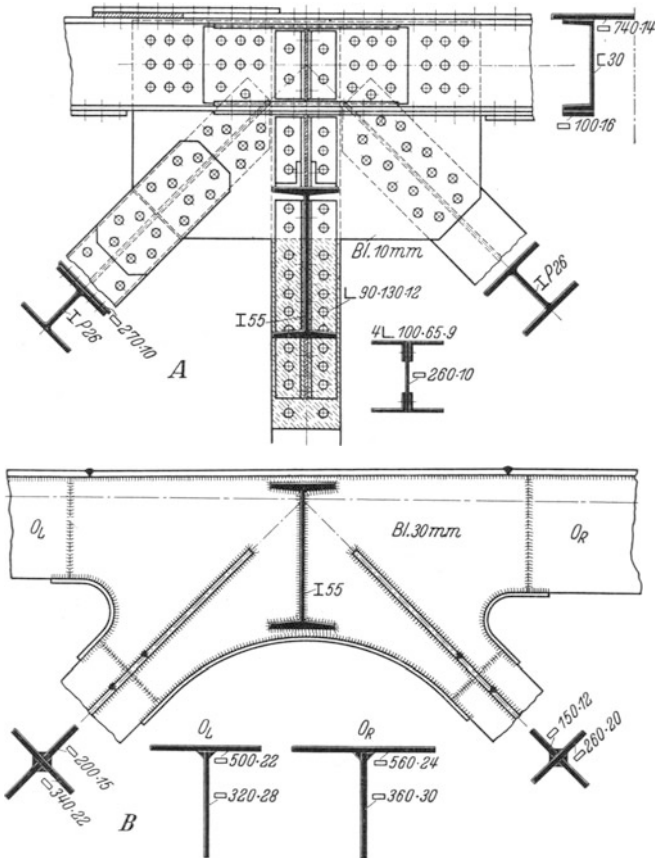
Genieteteter und geschweißter Knotenpunkt im Brückenbau.
